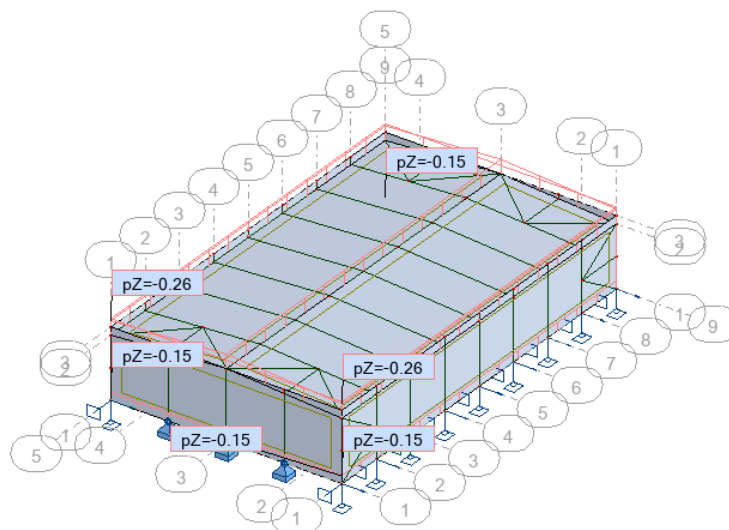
Aplicação no modelo estrutural das cargas permanentes
